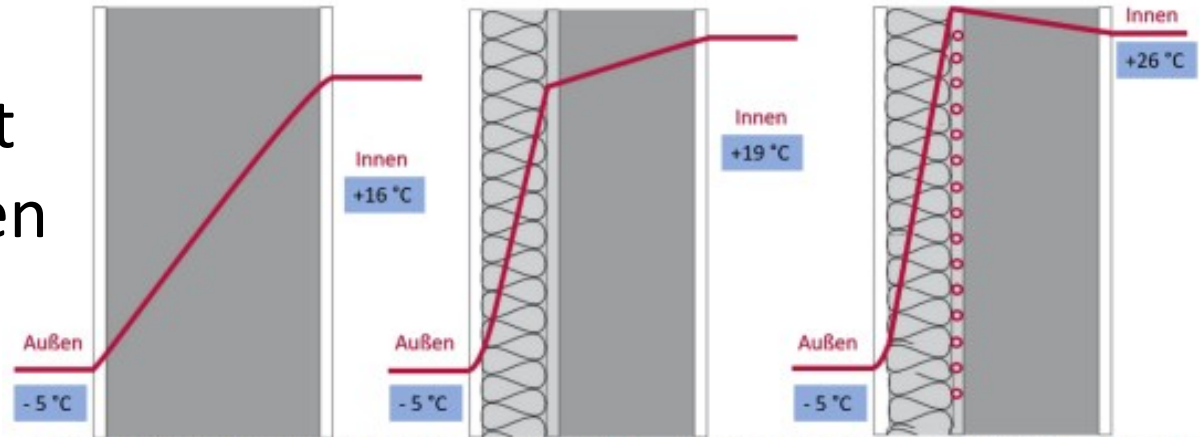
Wandaufbau ohne Dämmung, Wandaufbau mit Dämmung und Wandaufbau mit Außenwand Temperierung
